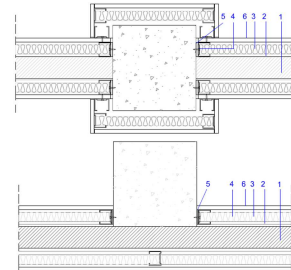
y 10 – Encuentros Tabique mixto con pilar
